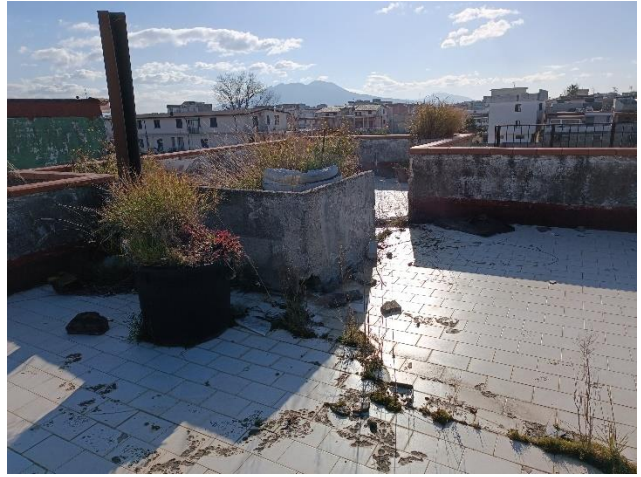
Foto 30: terrazzo quota piano lastrico solare
